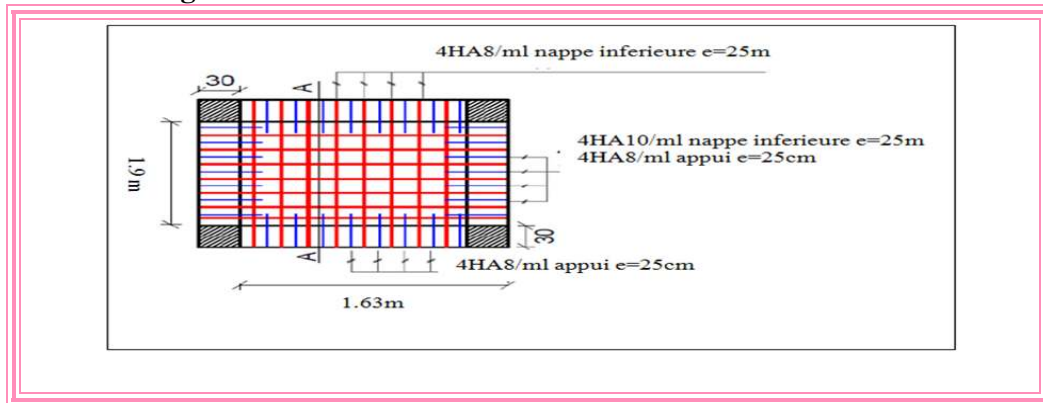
ferrailage de dalles au dessous de l'ascenseur et dalle salle machine
